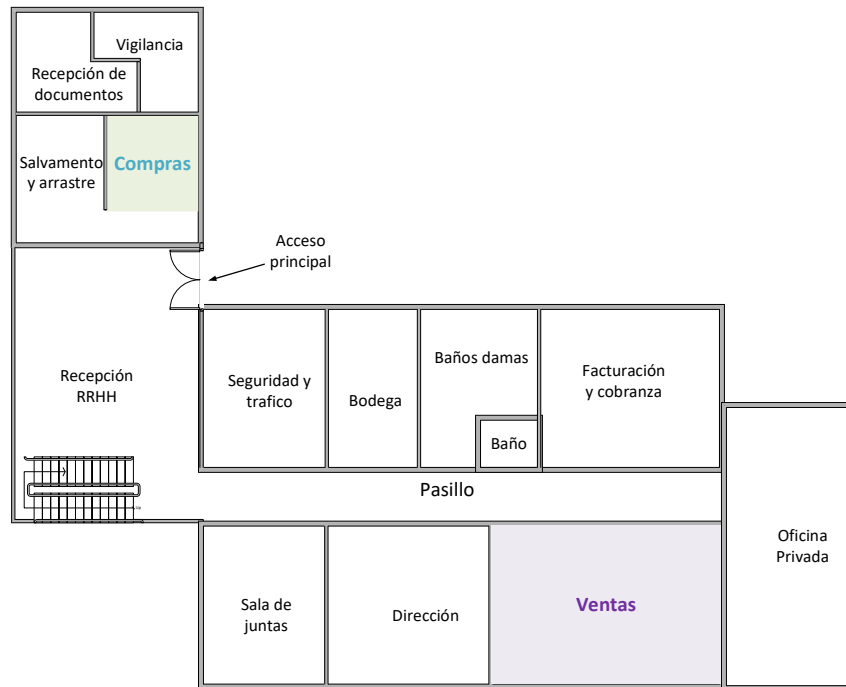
2 Distribución de la planta baja del edificio de oficinas (Fuente: Elaboración propia).
